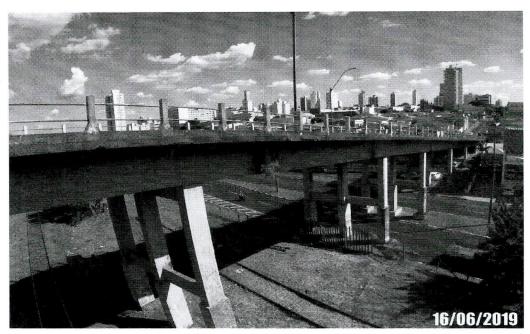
Vista da face lateral da viga com infiltração, eflorescência, desplacamento de concreto e vegetação.
